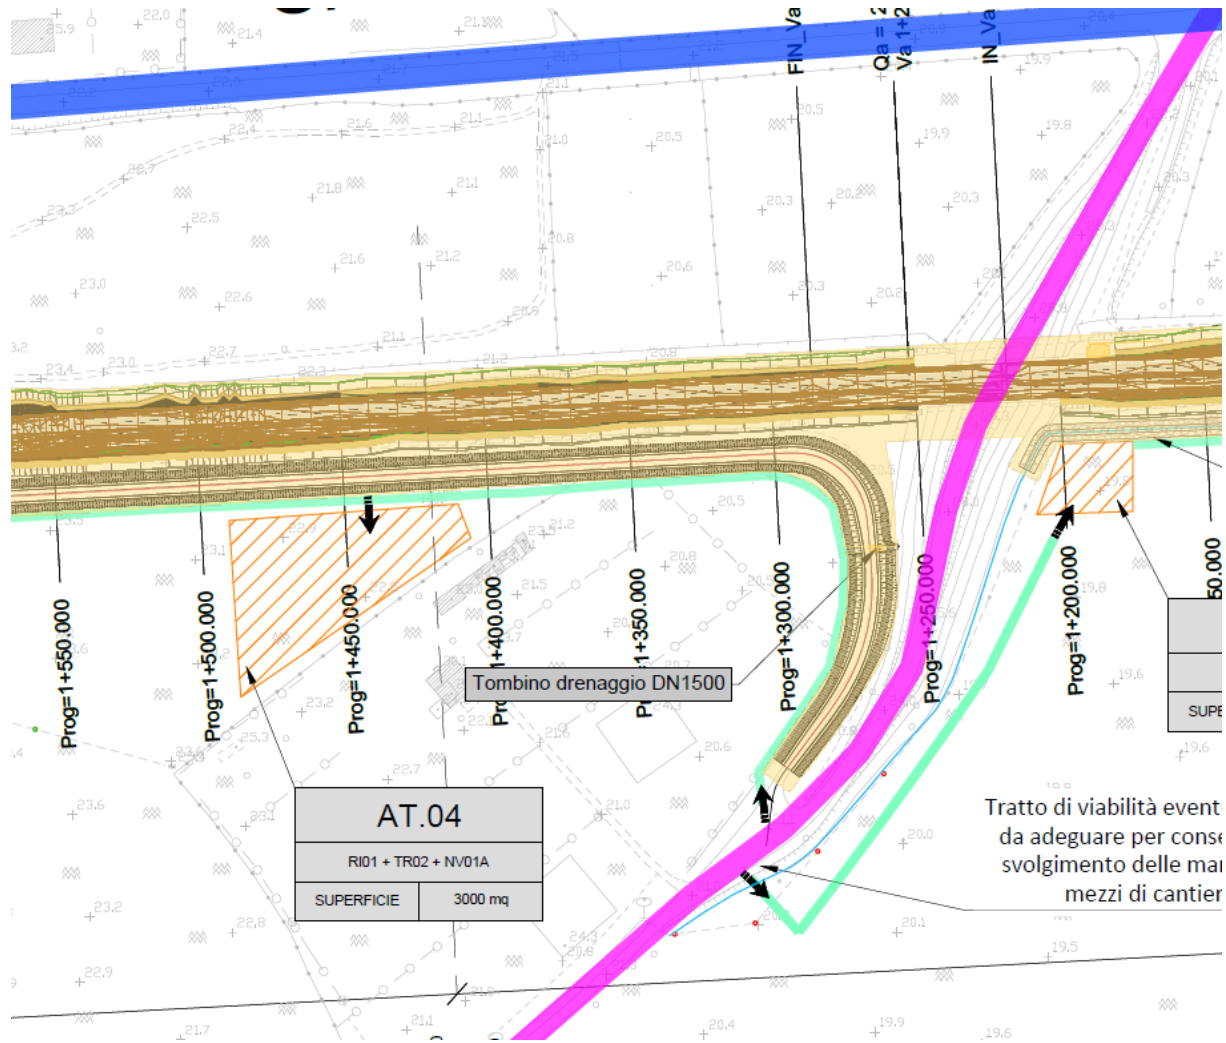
Vista in pianta dell'area di cantiere AT.04
